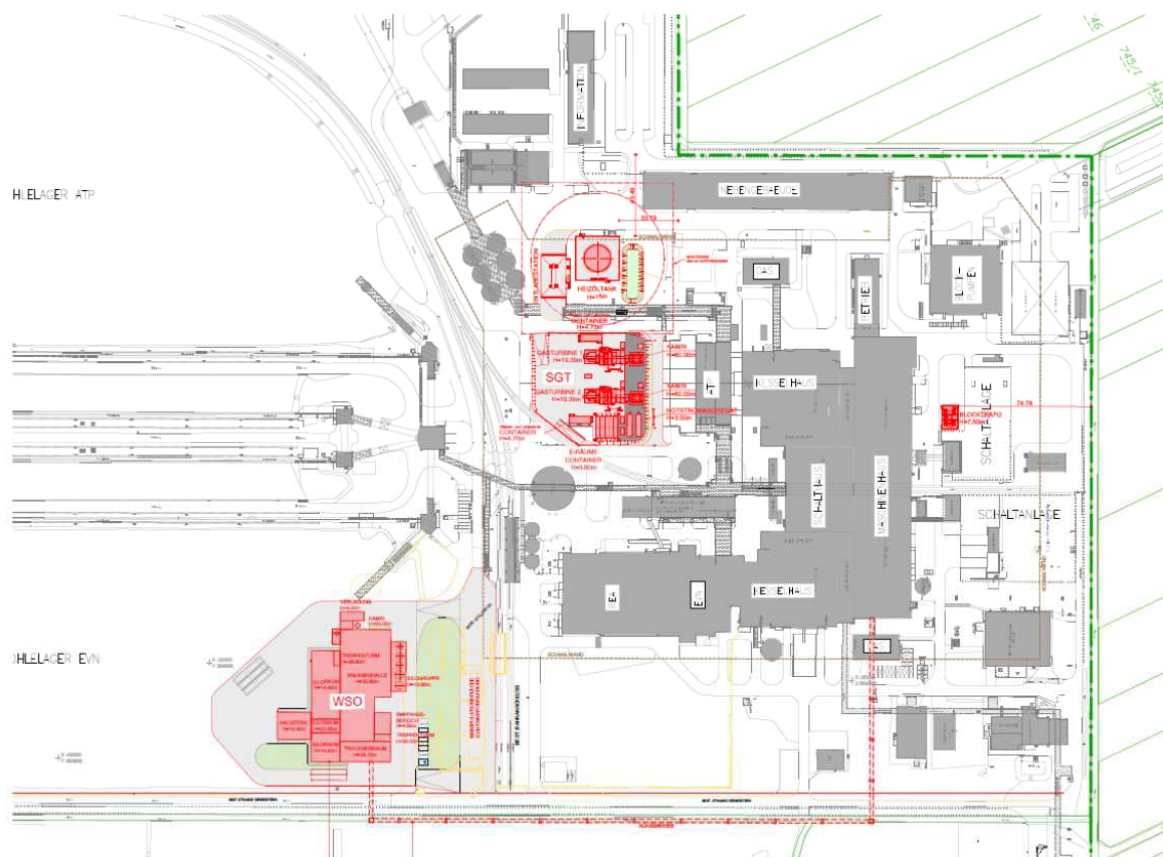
Übersichtslageplan der geplanten Projekte WSO und SGT am Betriebsgelände Kraftwerk Dürnrohr
